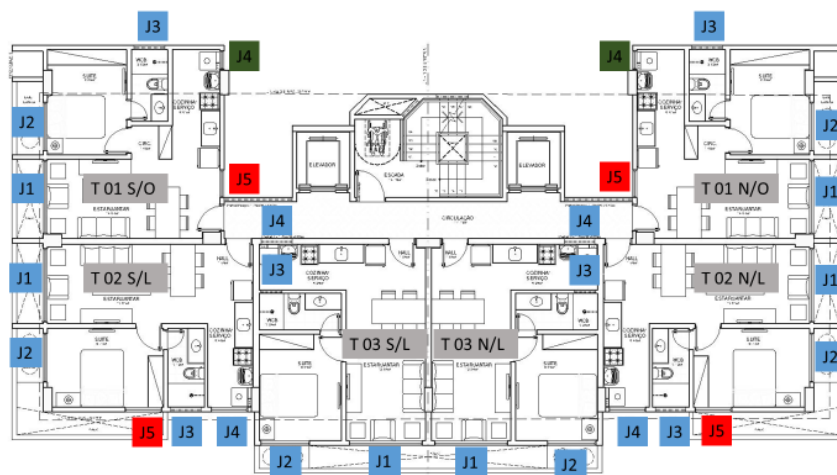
Planta baixa revisada do pavimento tipo do Edifício.
